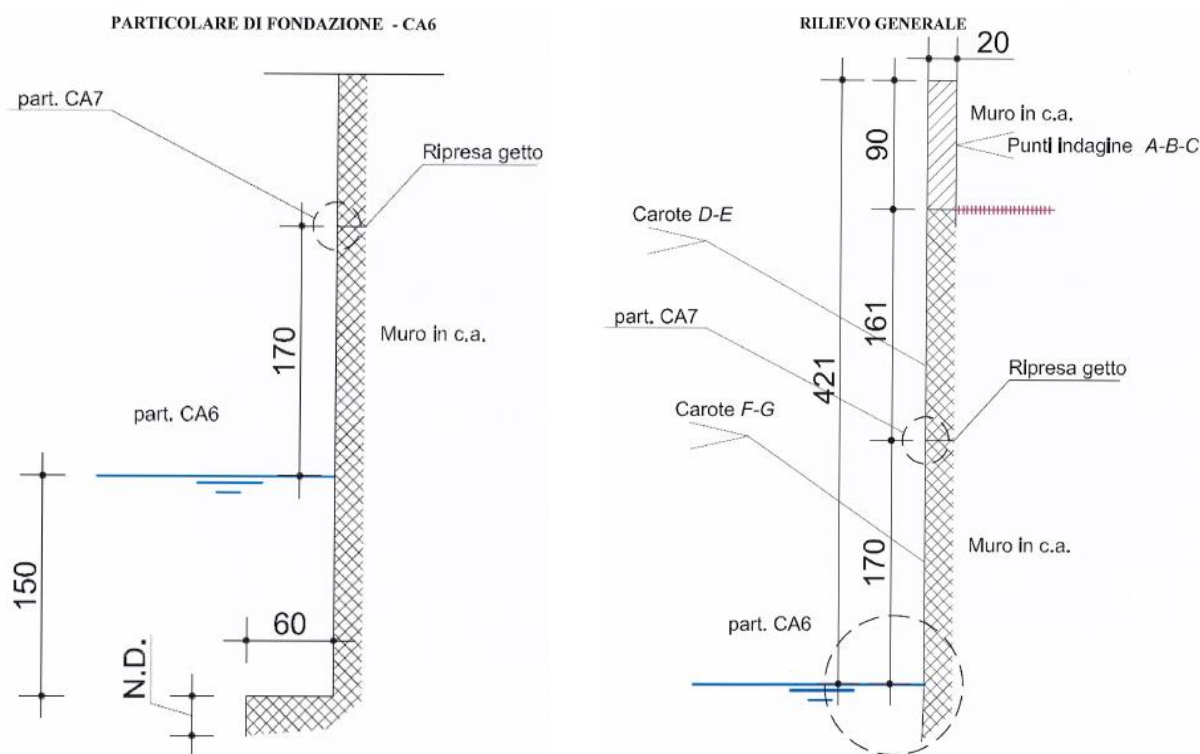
Sezione tipologica strutturale rilevata in sito
